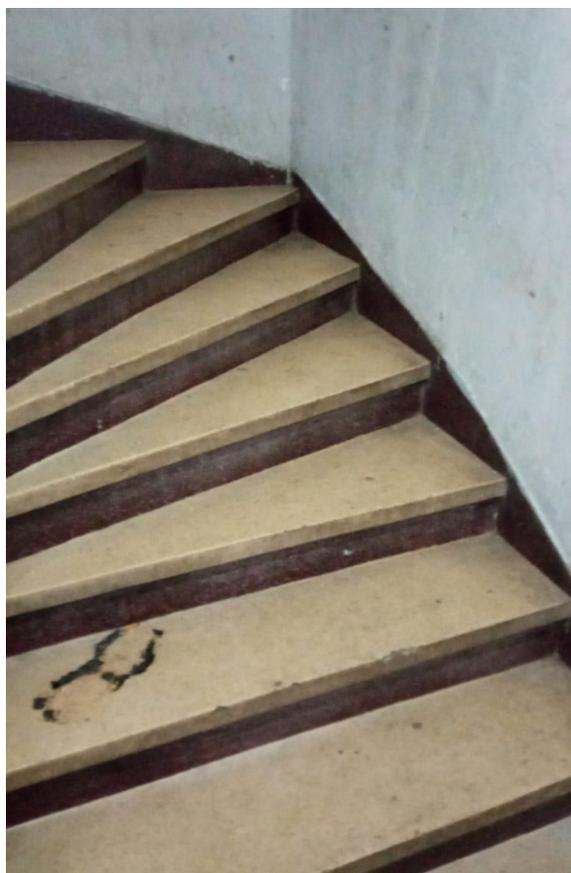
escada da edificação, em bom estado de conservação, mas sem fita antiderrapante e corrimão.
